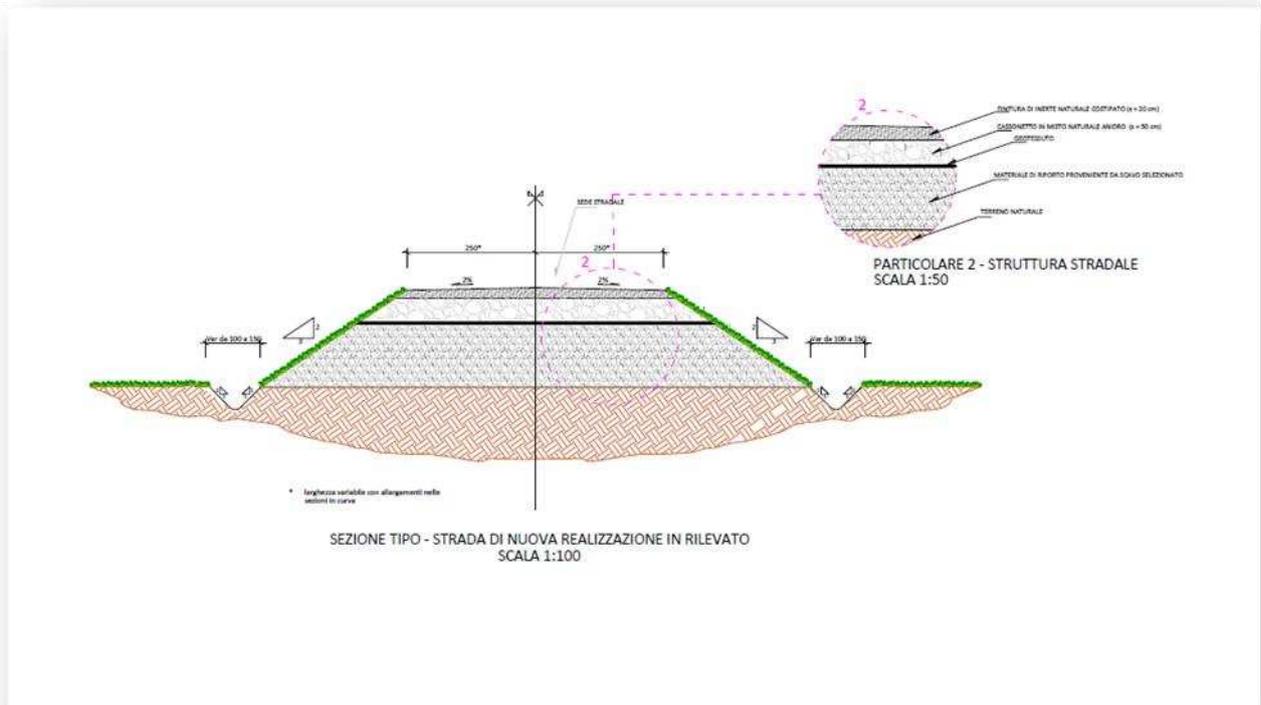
Estratto elaborato EDP0055 (Sezione stradali tipo e viabilità)
